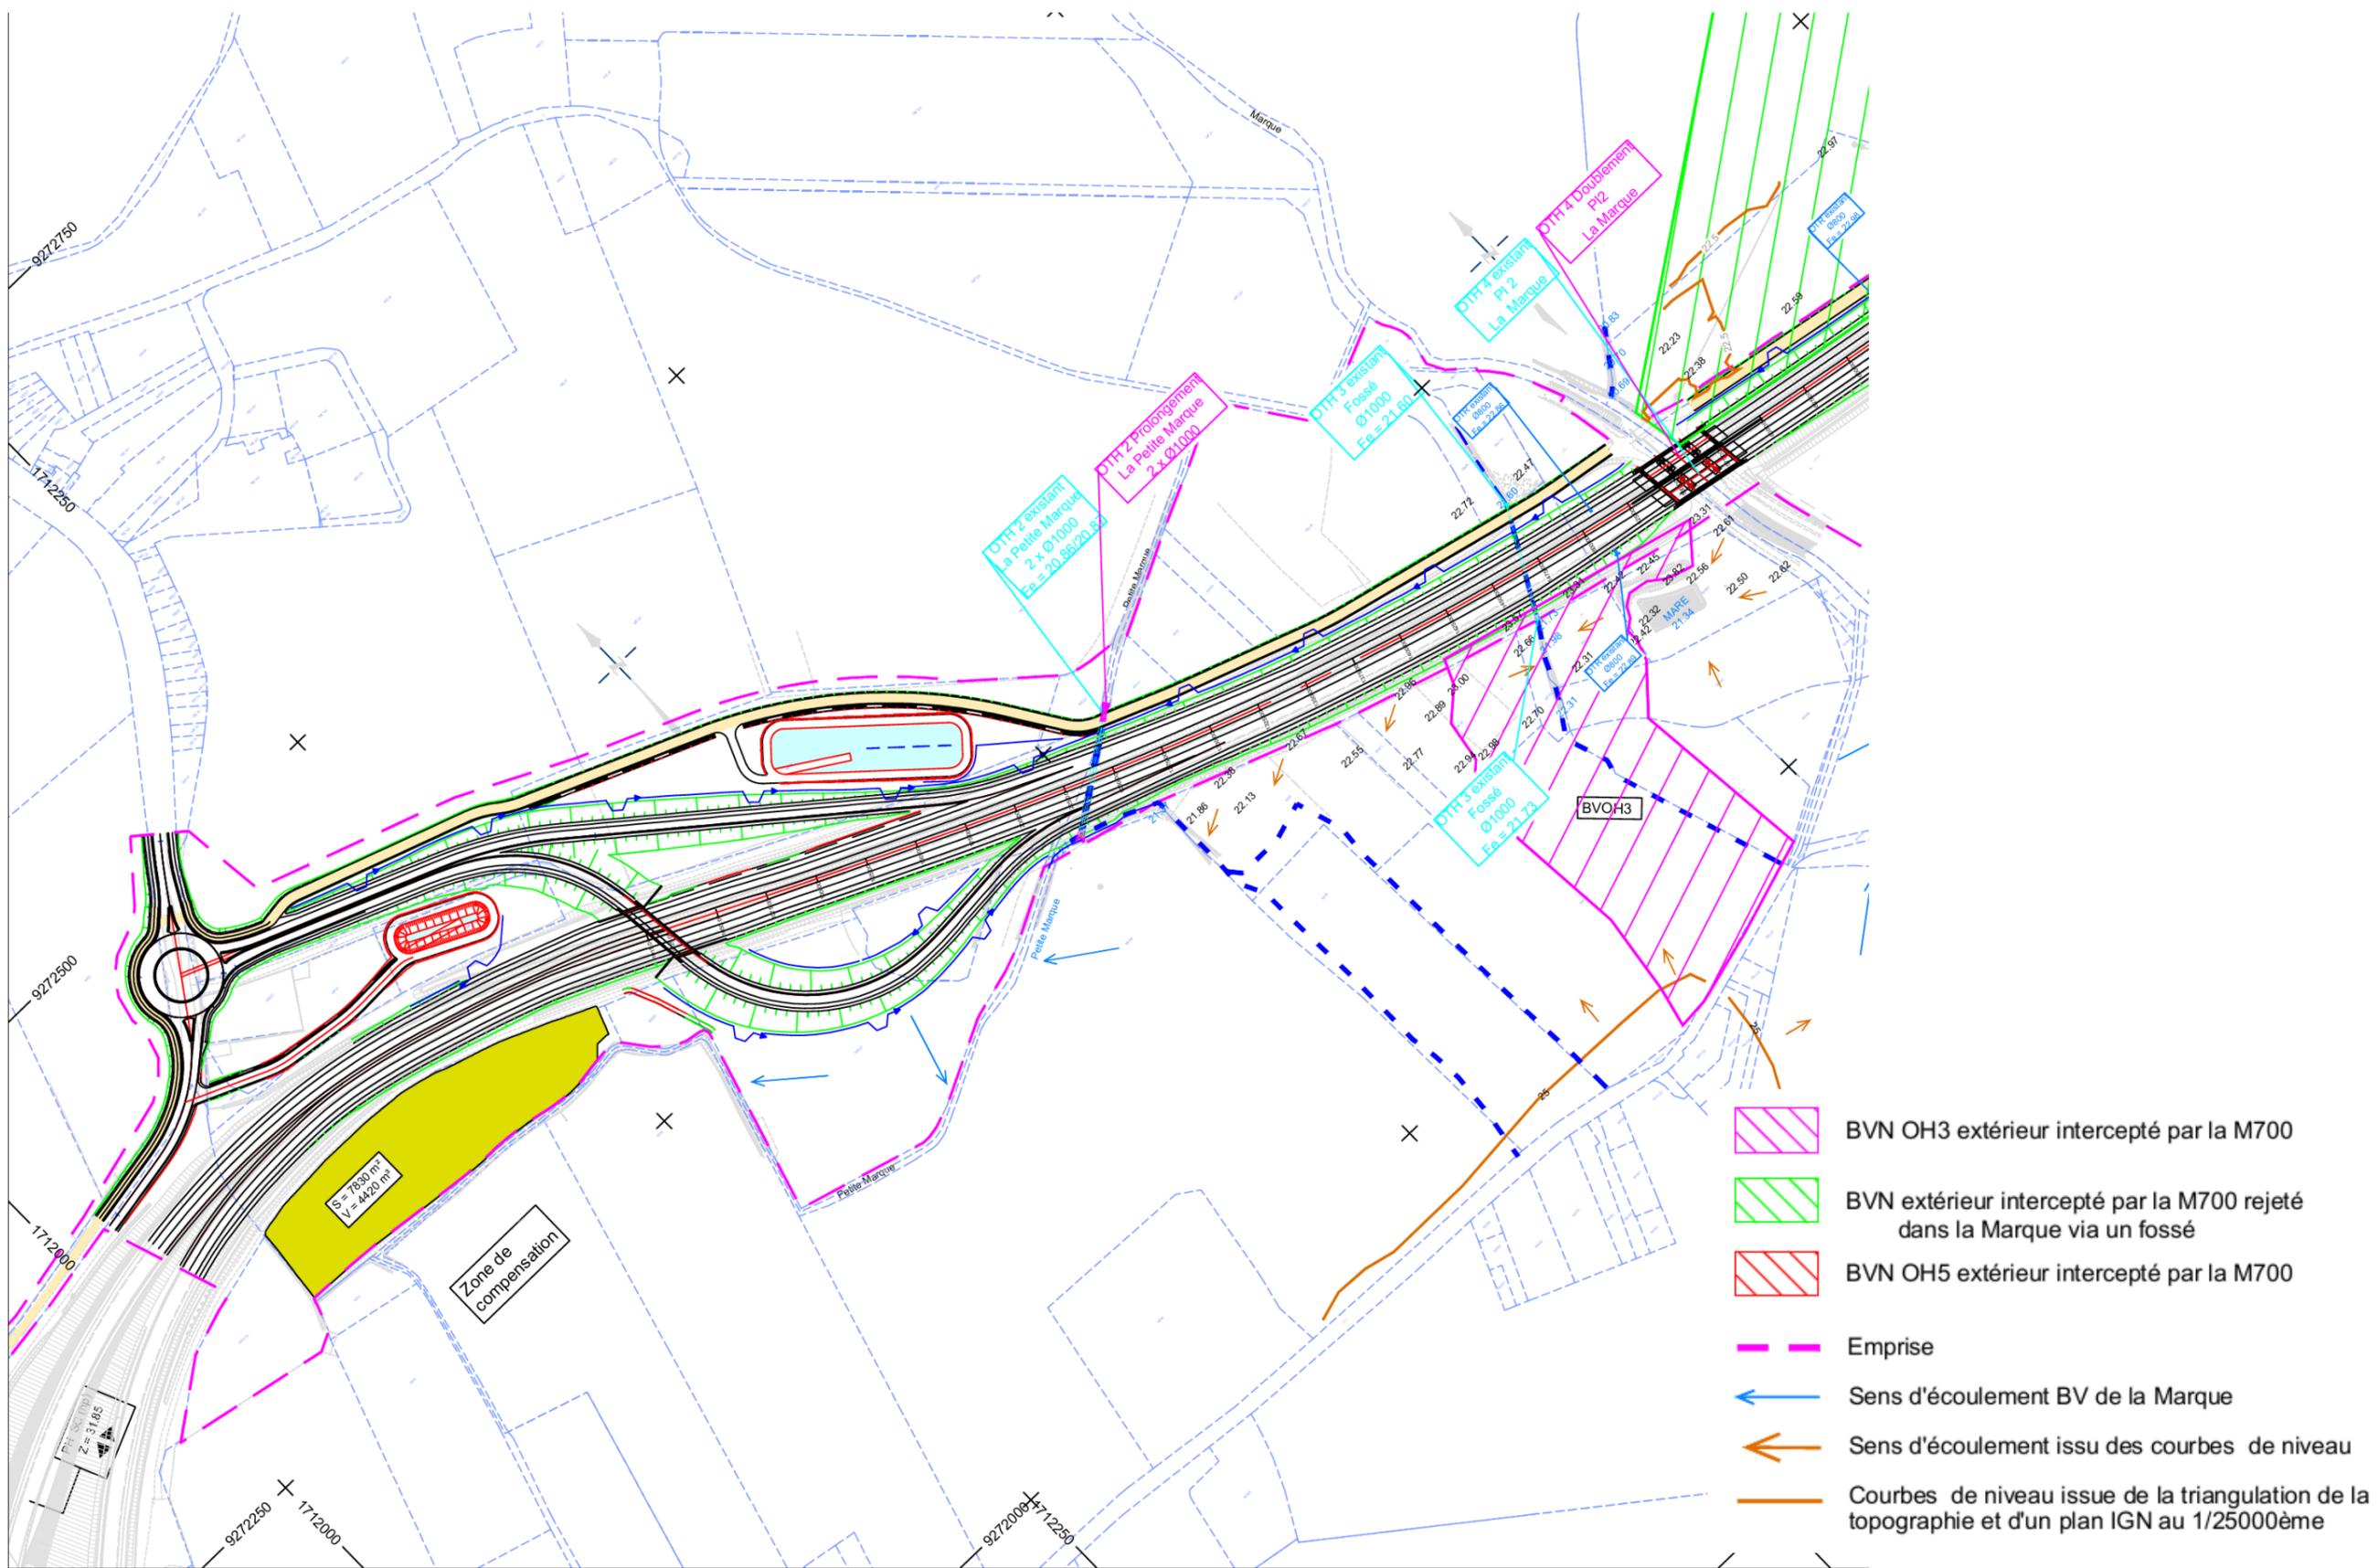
Bassins versant interceptés et ouvrages de transparence hydraulique sur plan parcellaire 1/2
